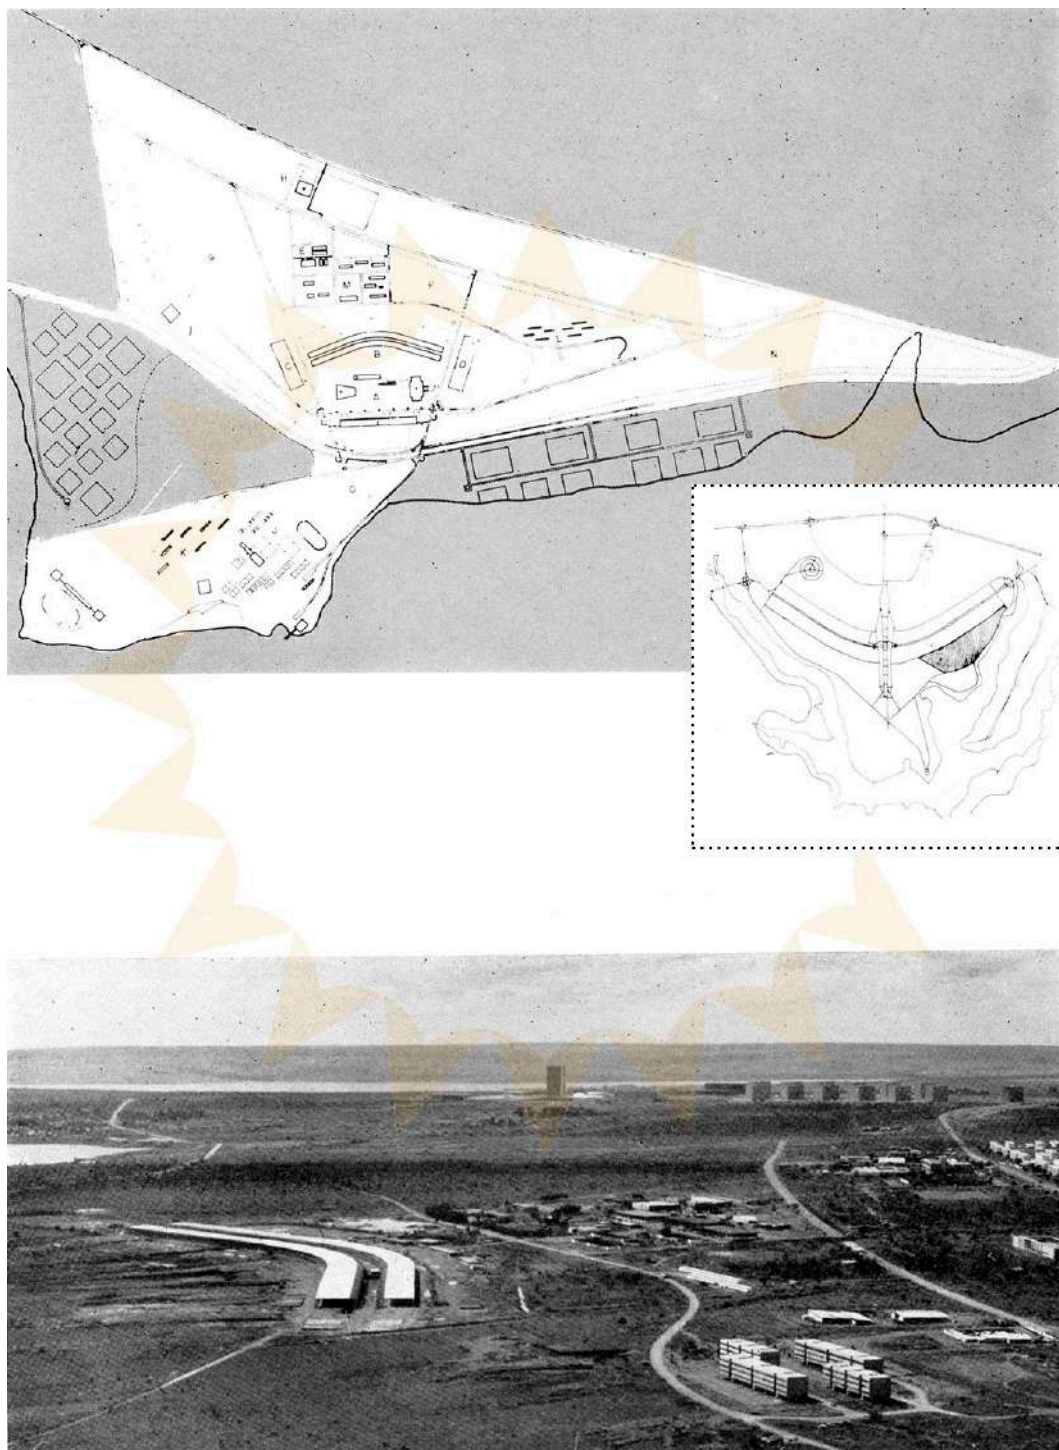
Plano Piloto da UnB, revisto pelo Ceplan, acima, e vista aérea do campus, em construção, com destaque para o edifício do Instituto Central de Ciências, abaixo.
